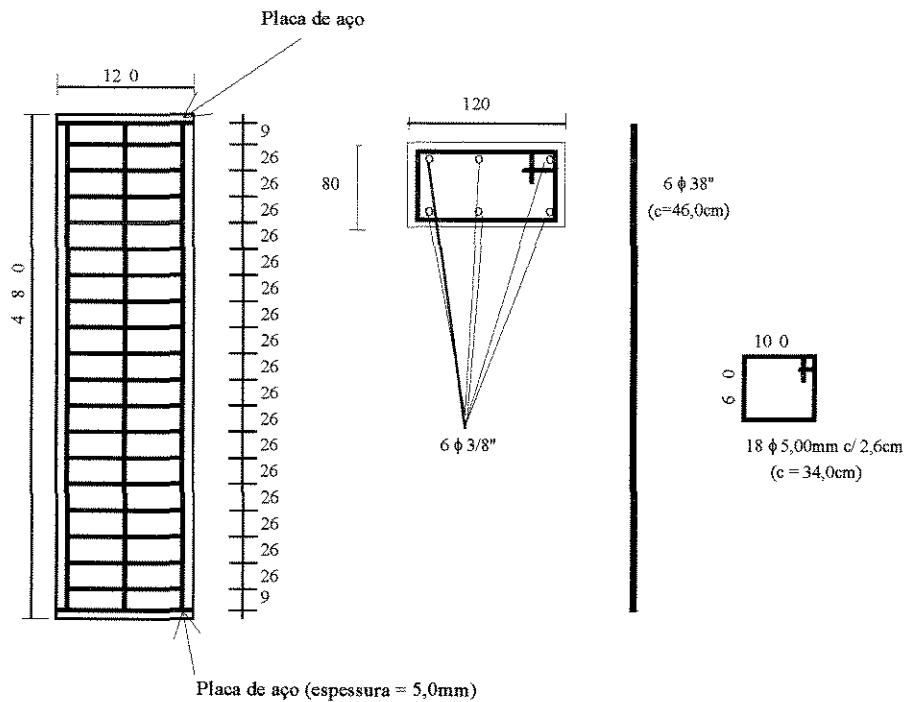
Detalhamento das armaduras dos pilares P8/12-225 e P8/12-250
